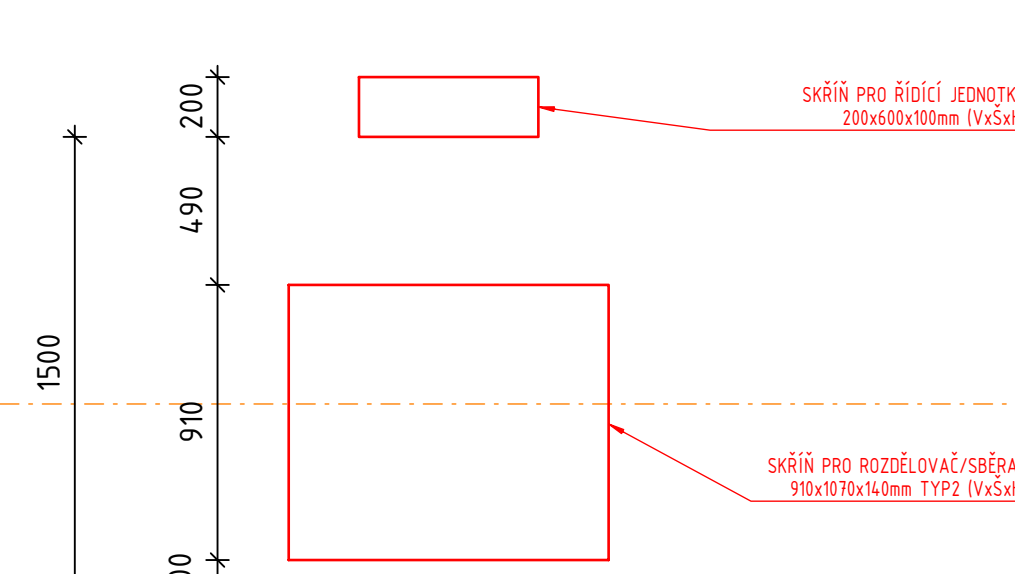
DETAIL UMÍSTĚNÍ ROZDĚLOVAČ
